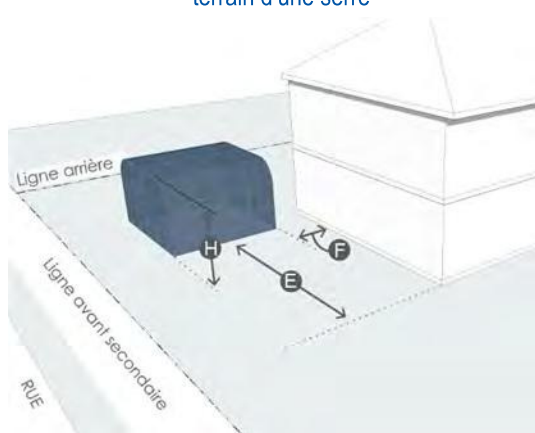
Distance minimale du bâtiment principal, retrait minimal par rapport au plan principal de la façade principale avant et hauteur maximale d'une serre
